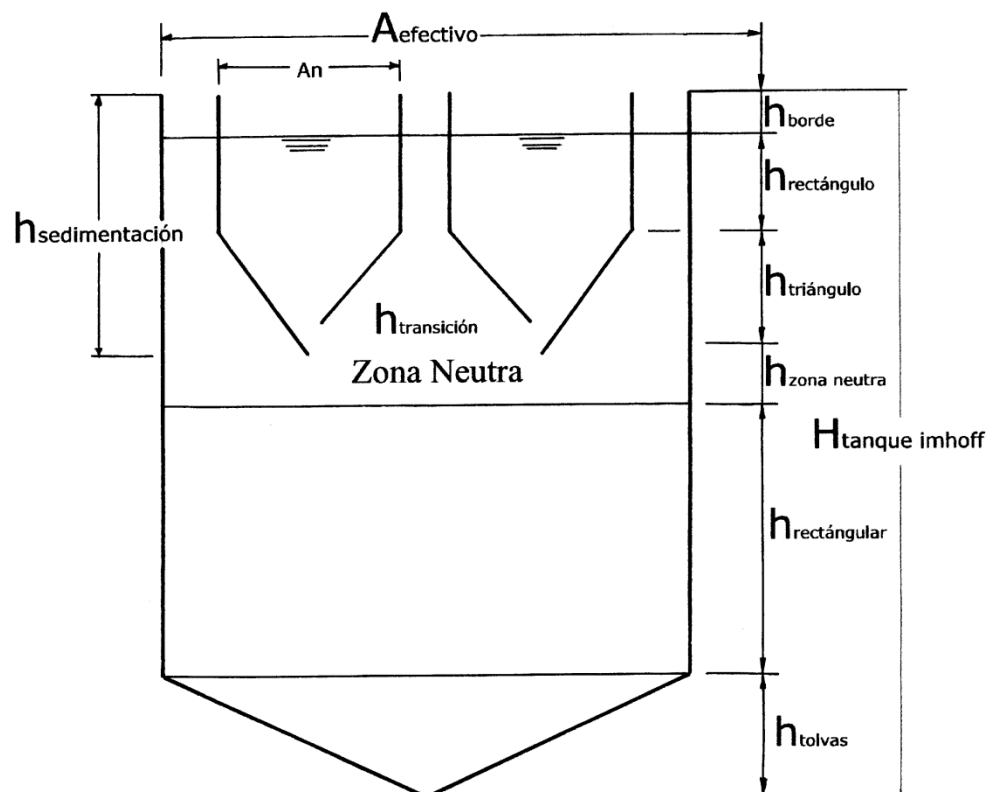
Esquema de dimensionamiento de un tanque Imhoff
